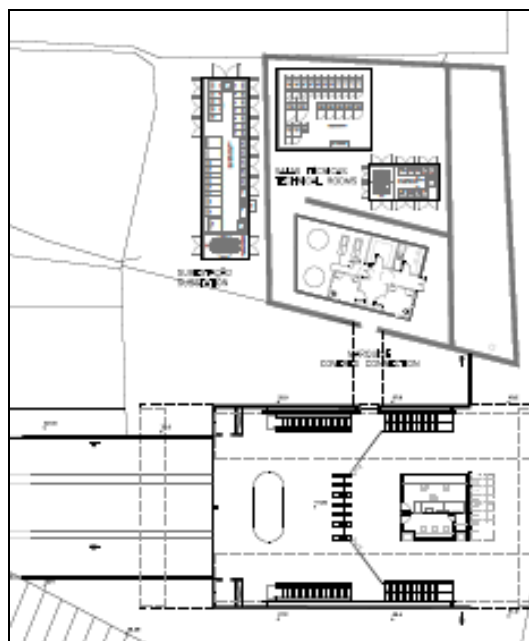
Planta Baixa da Parada Soledade e do Edifício Solar Bandeira.
